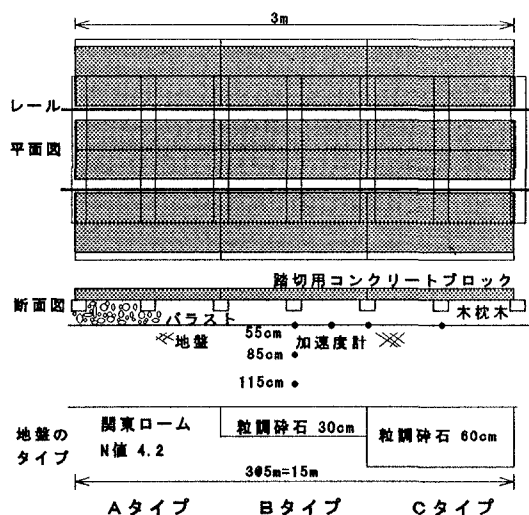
地盤と踏切コンクリートブロック軌道構造の概略図
